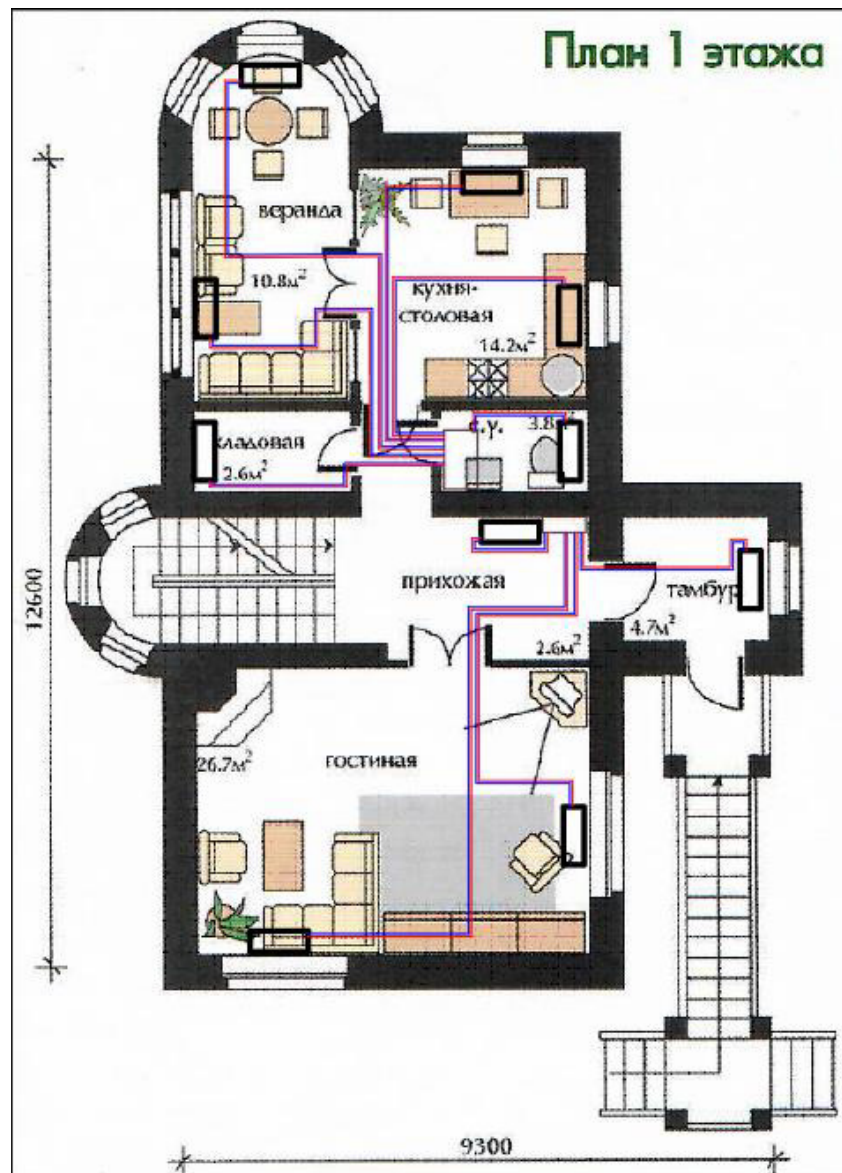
схема расположения отопительных приборов в помещениях первого этажа.
